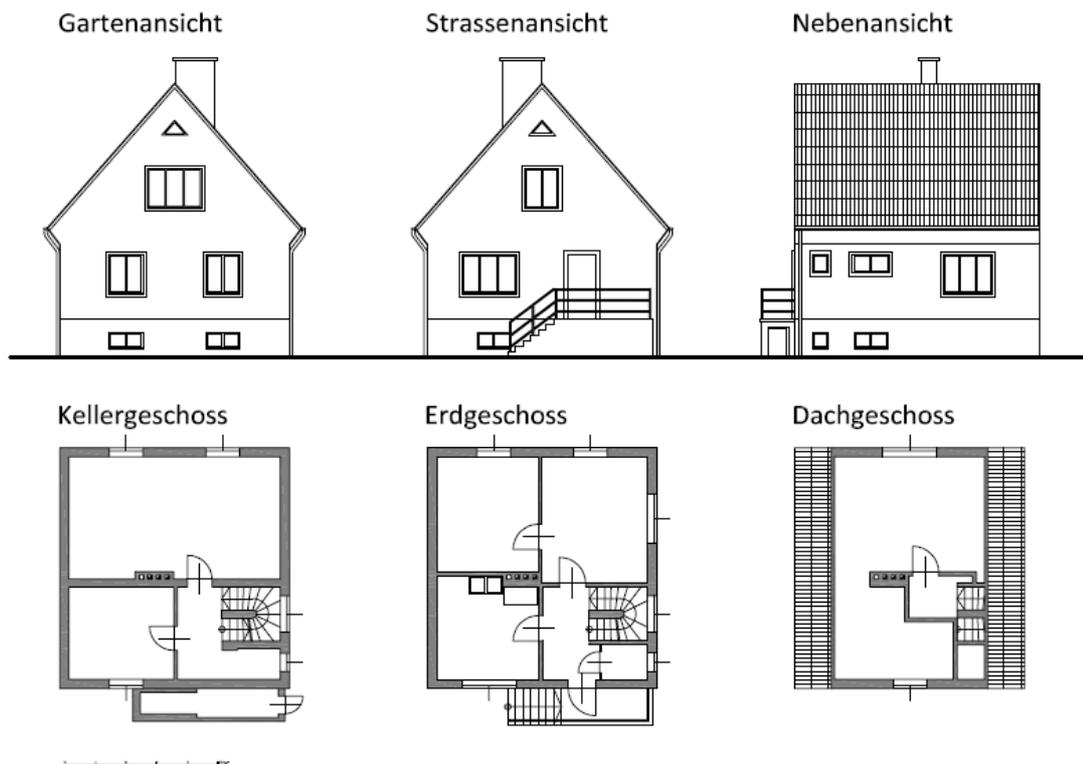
Ansichten und Grundrisse der Ausgangssituation⁸²
